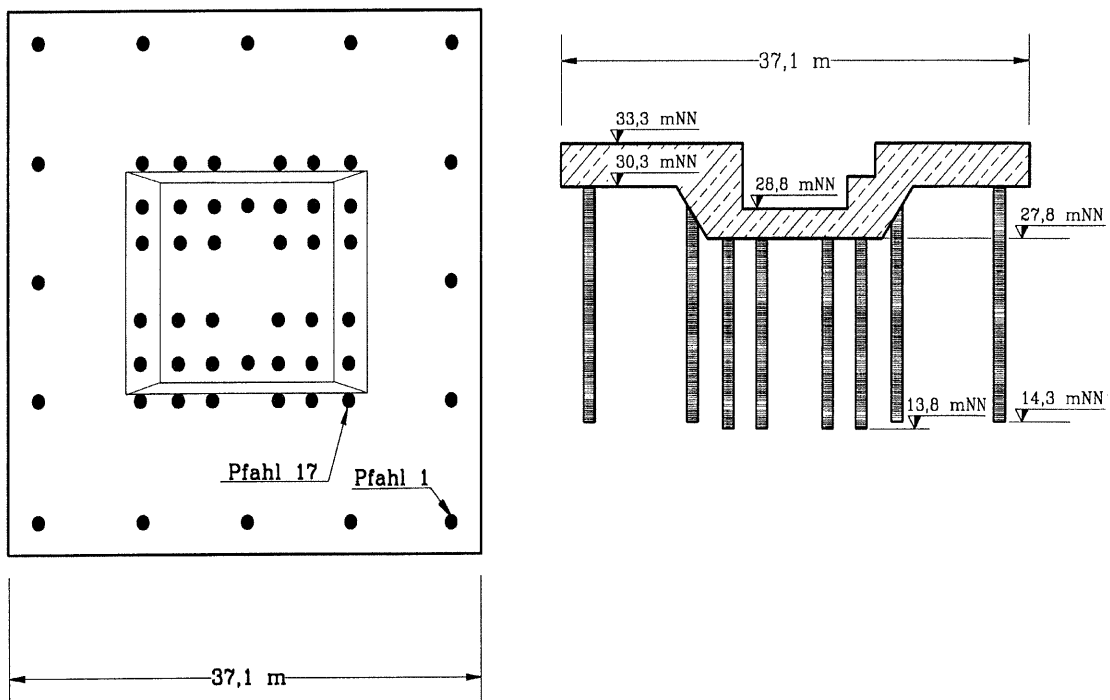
TREPTOWERS - KPP im Schnitt und im Grundriß
